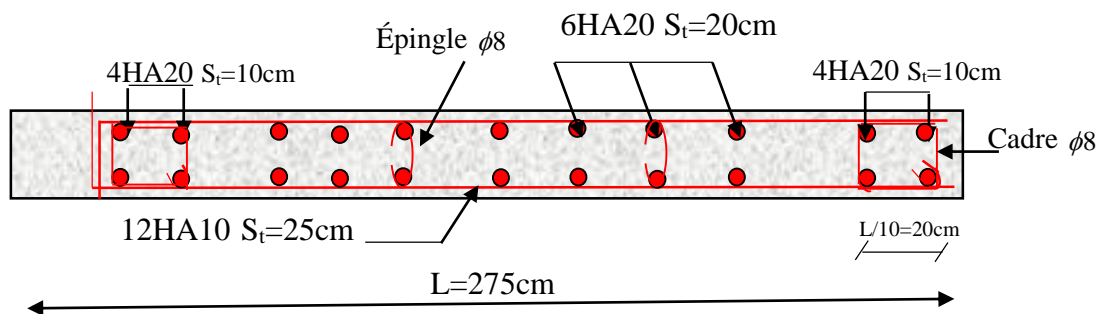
Schéma de ferrailage du voile V_{x1}
